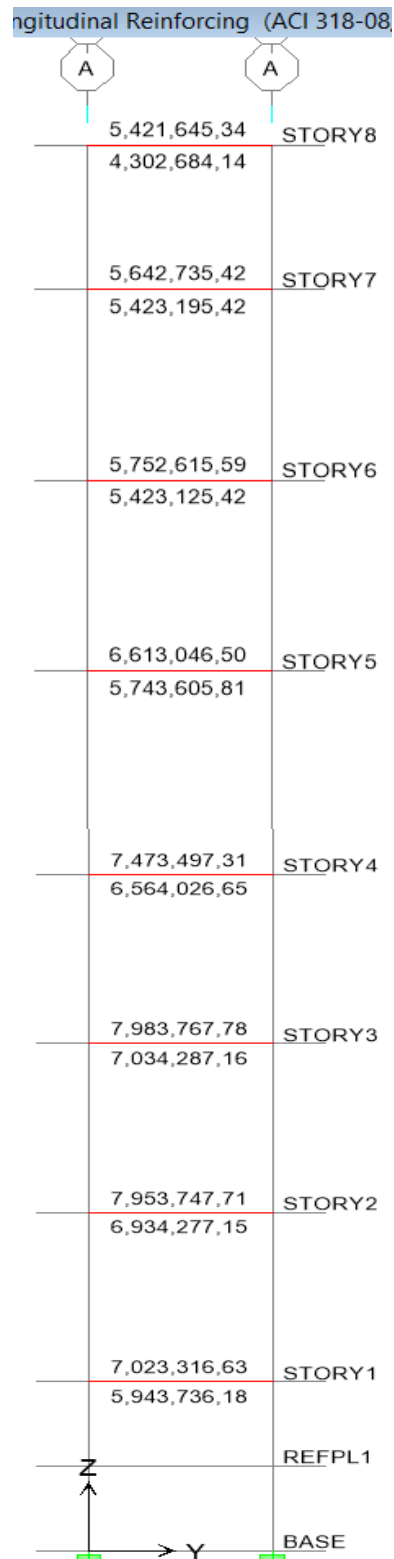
Acero en Vigas y Columnas en el Pórtico A – Escaleras de Emergencia Hospitalización 2- (NEC-11)
